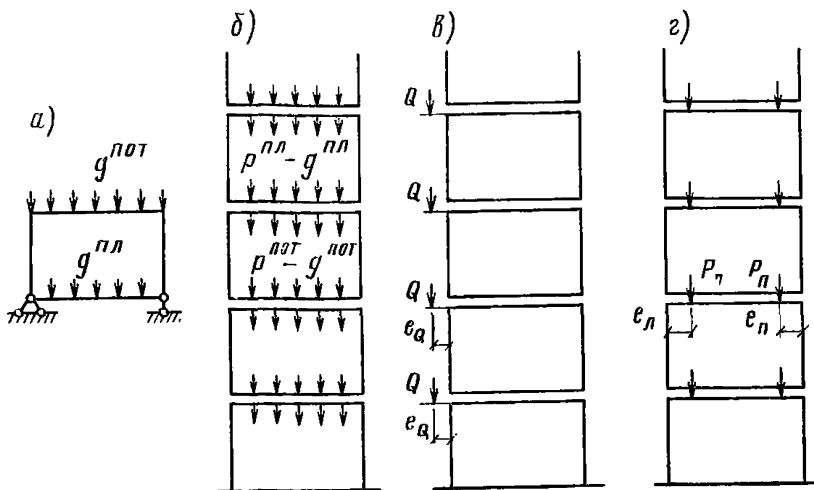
Схемы расчета на действие нагрузок от собственного веса g (а); полных, за исключением собственного веса, $\rho - g$ (б); от плит перекрытий Q (в); от веса вышележащих этажей (з)
